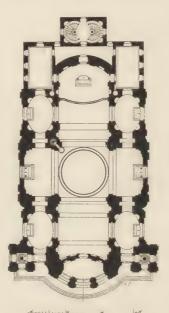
Kollegienkirche zu Salzburg Grundriss,
